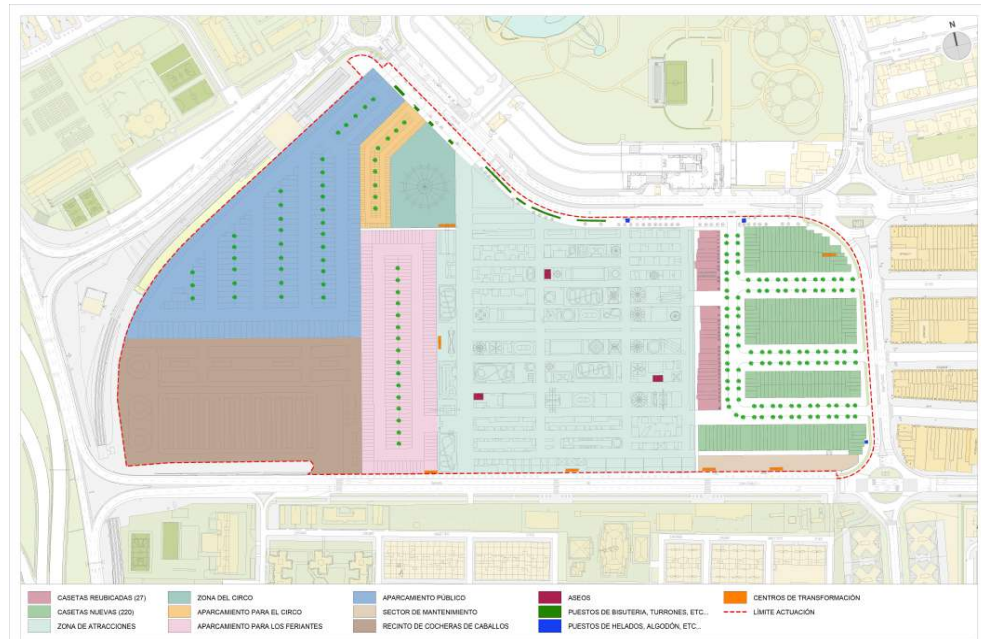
Propuesta de Ordenación. Fuente: Plano 03 del Anteproyecto.
